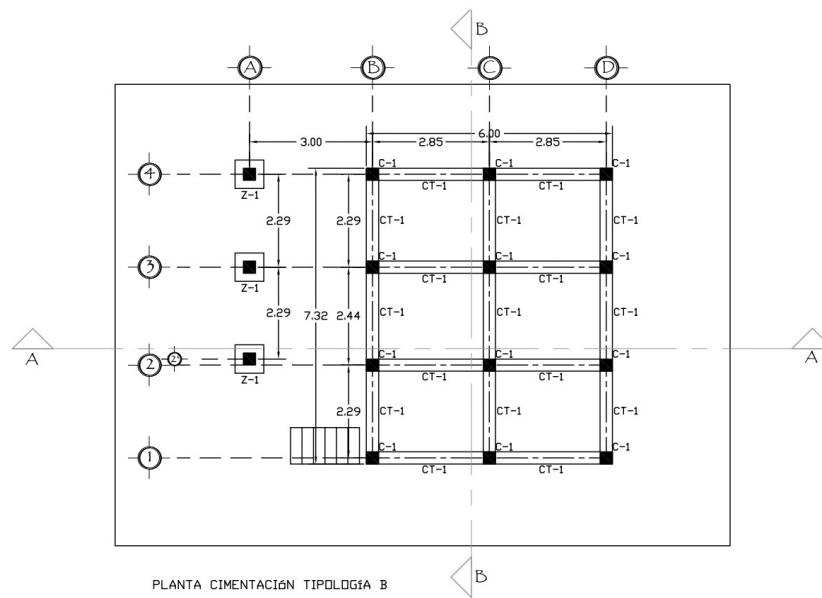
Planta Cimentación Tipología - B - Elaboración propia
